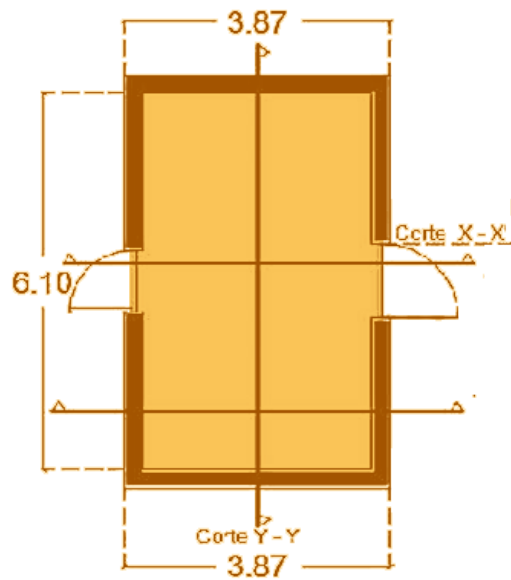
Planta de casa azotea en el predio de la casa #33. Hernández, 2018.
